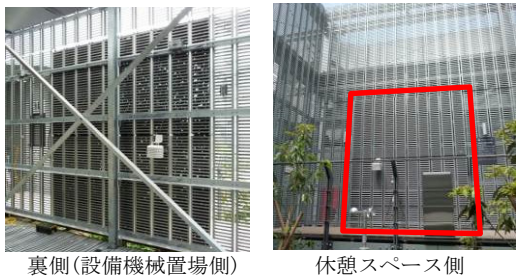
屋上休憩スペースの保水冷却パネル(保水石材)
